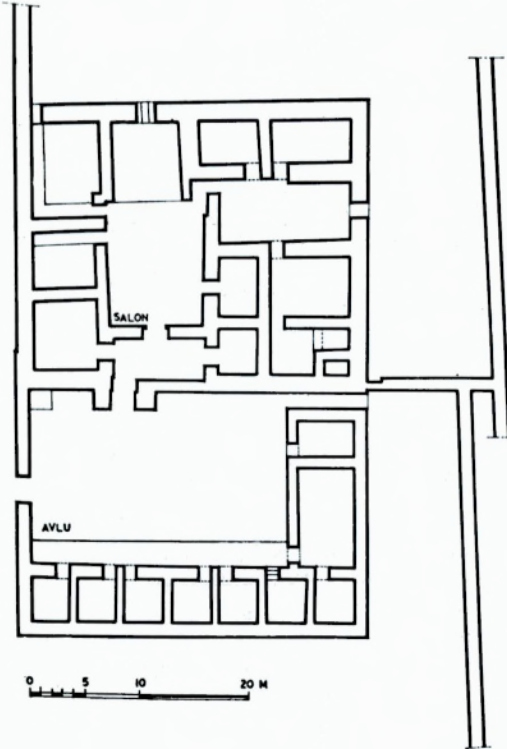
Kayseri, Haydar Bey Köşkü Planı (A. Gabriel'den)
